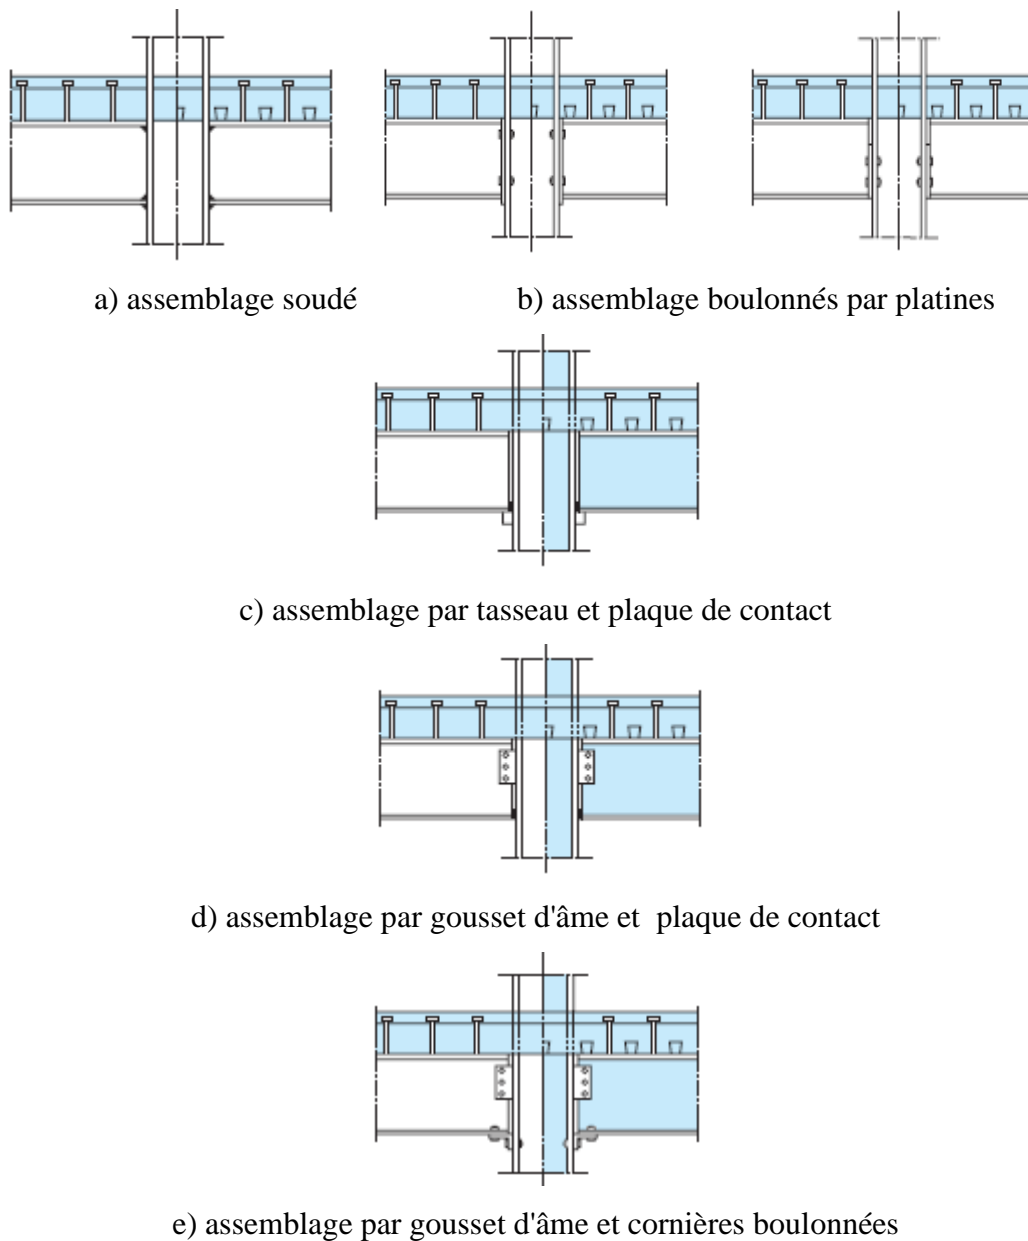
assemblage de type poutre-poteau pour des ossatures mixtes semi-continues
